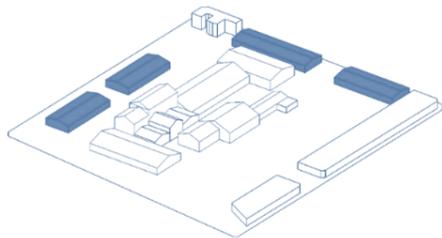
Ubicación de tipología en el conjunto Fuente:
